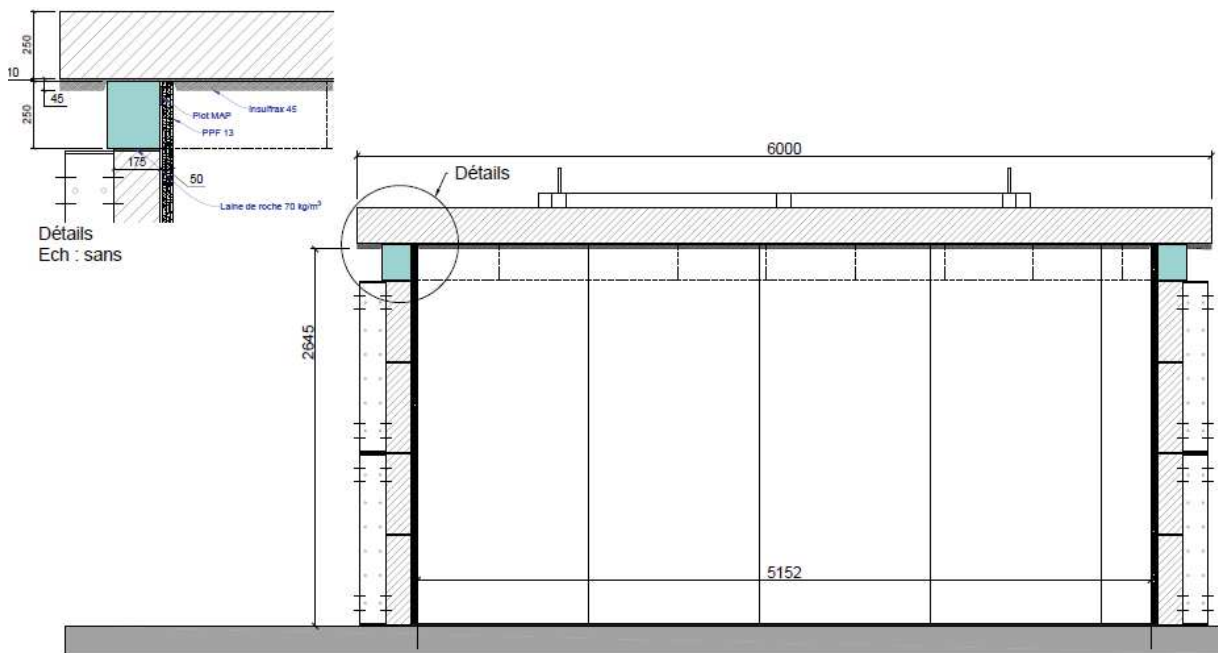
Coupe AA de la cellule d'essai pour l'essai 0 (sans bois) avec détail
